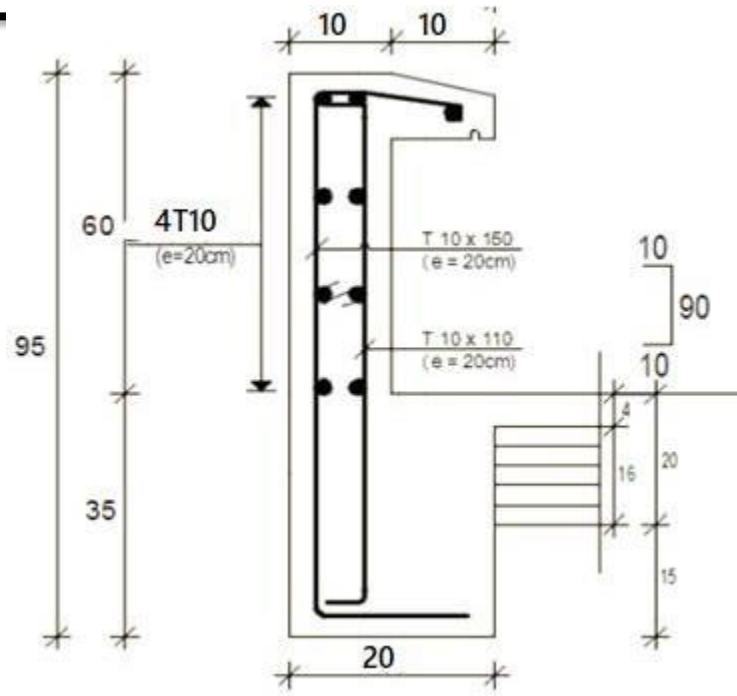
schéma de ferrailage de l'acrotère.
